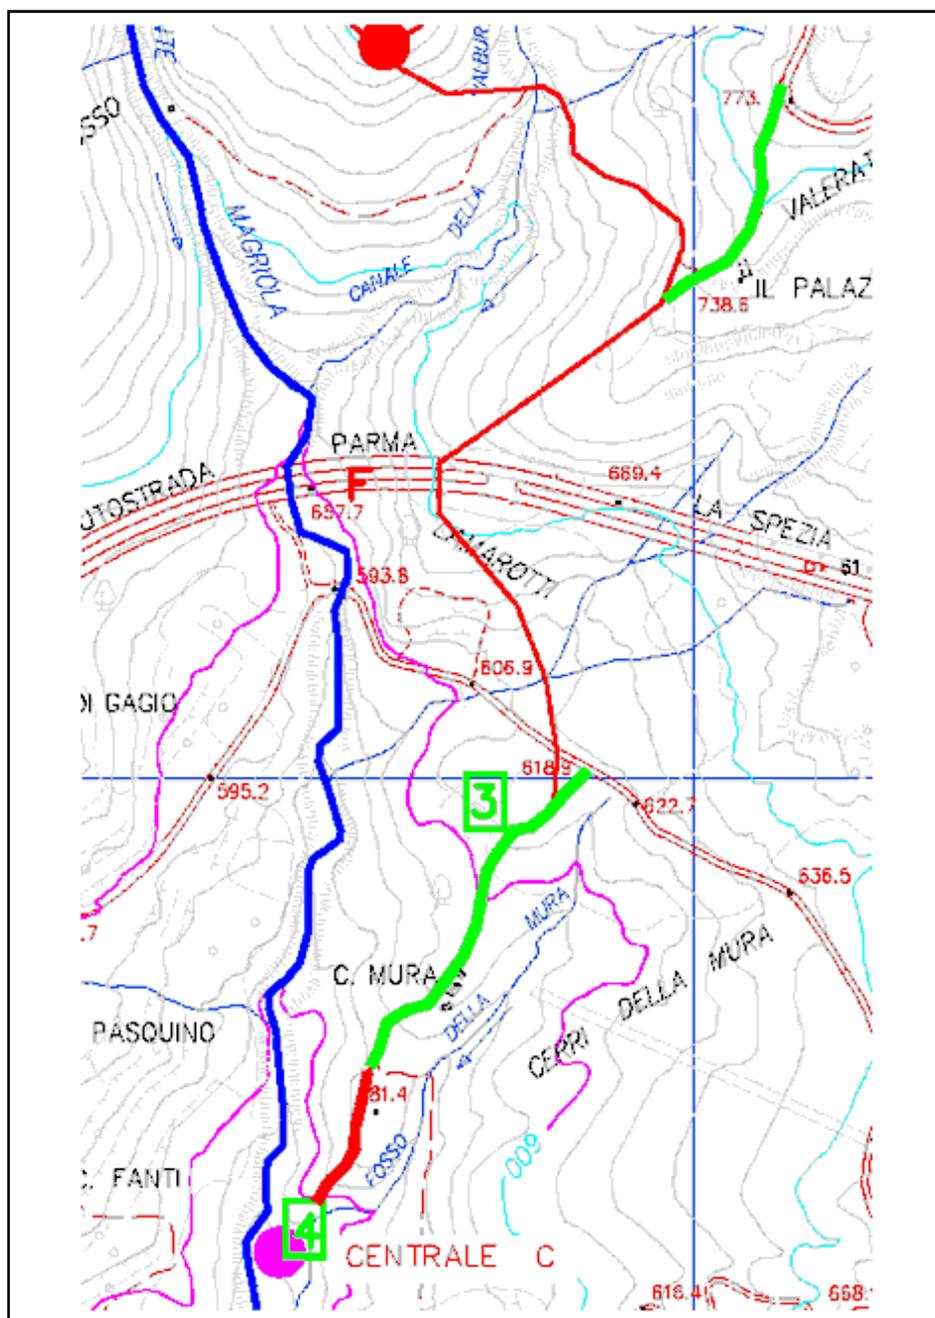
Ubicazione aree di cantiere (3 e 4) con piste di accesso.
